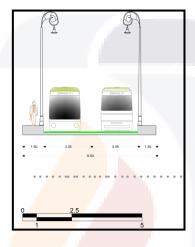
Sección transversal de la propuesta de adecuación en la calle Colón
